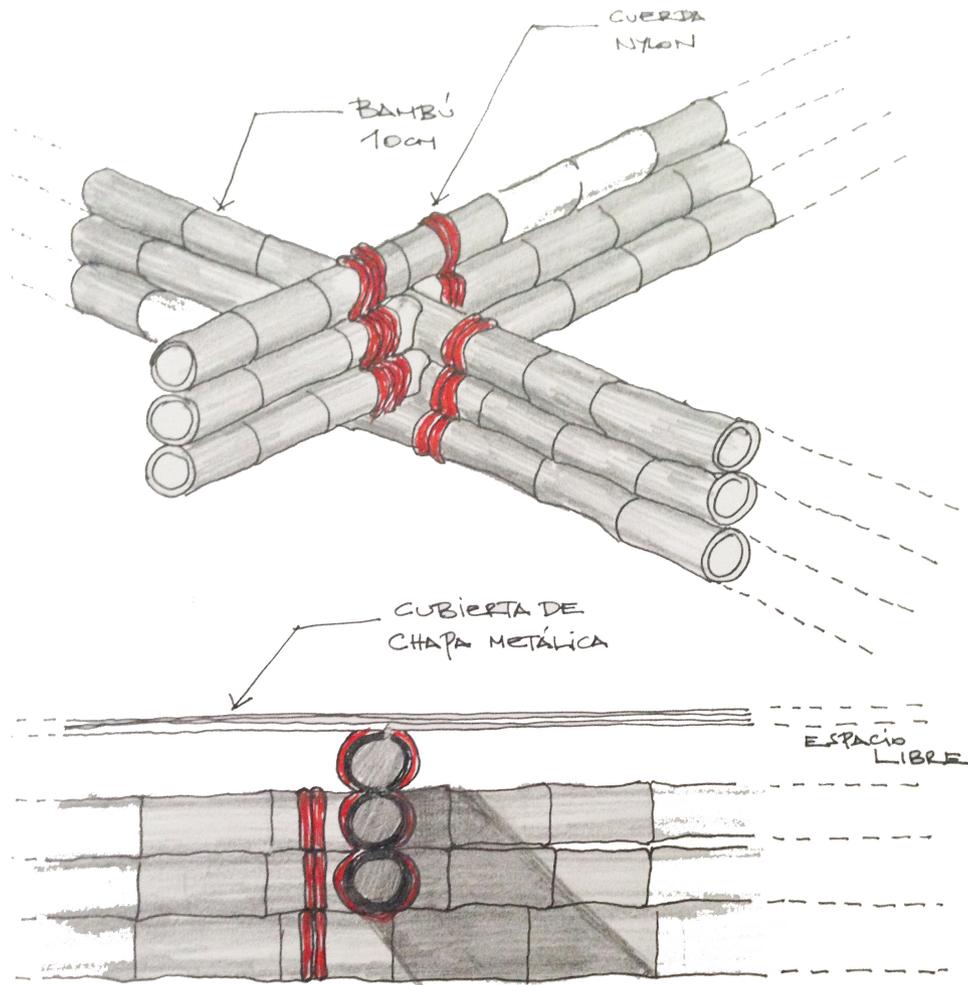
Boceto en el cual se analiza el armado de las vigas compuestas. Vigas tipo que soportan la cubierta. (Fuente: elaboración propia).
